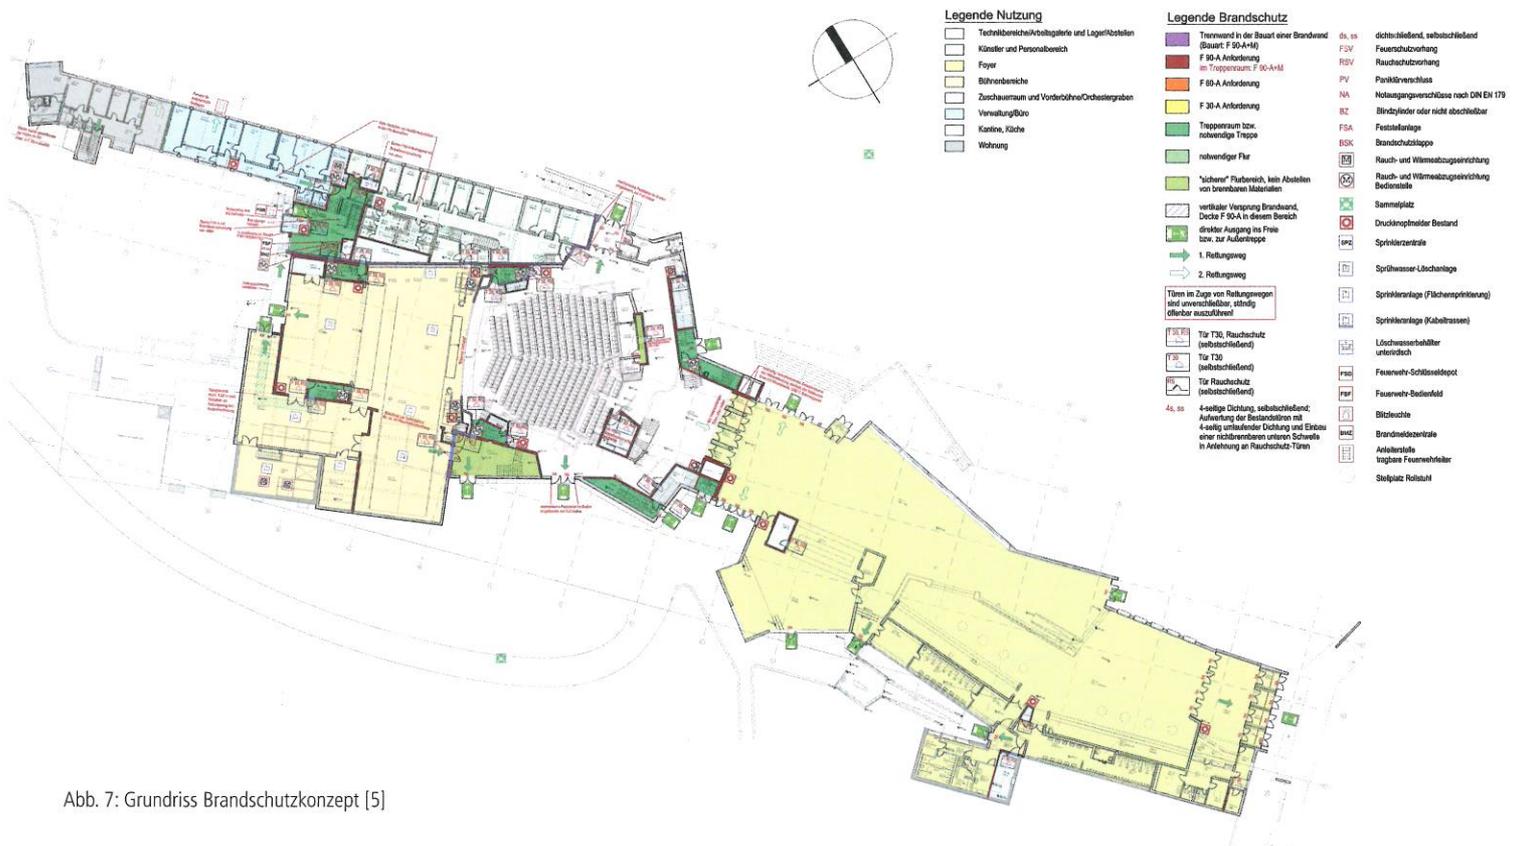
Grundriss Brandschutzkonzept [5]
